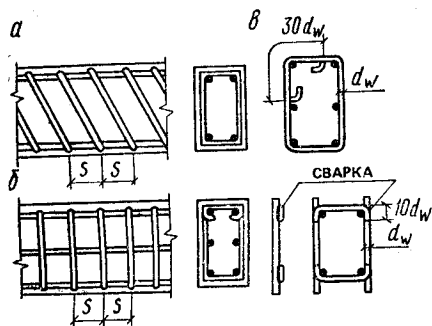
Армирование элементов прямоугольного сечения, испытывающих изгиб с кручением
